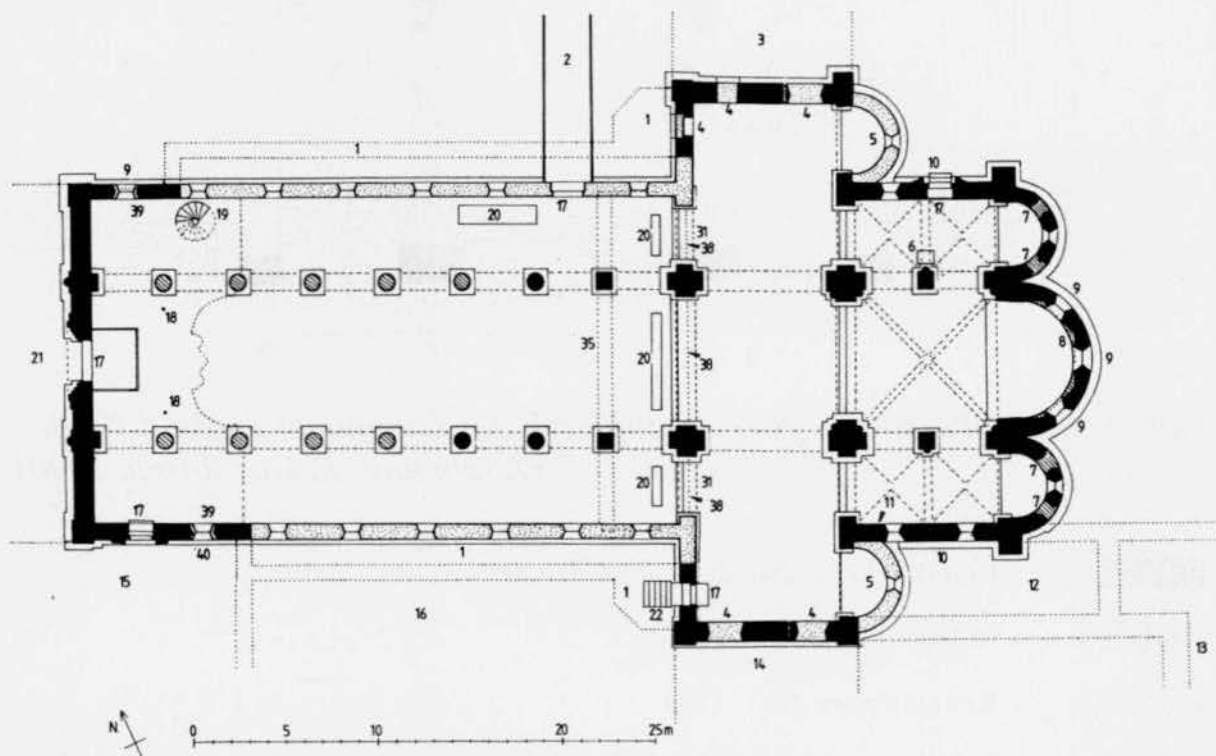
Baualtersplan, Grundriß; Zustand 1990.
